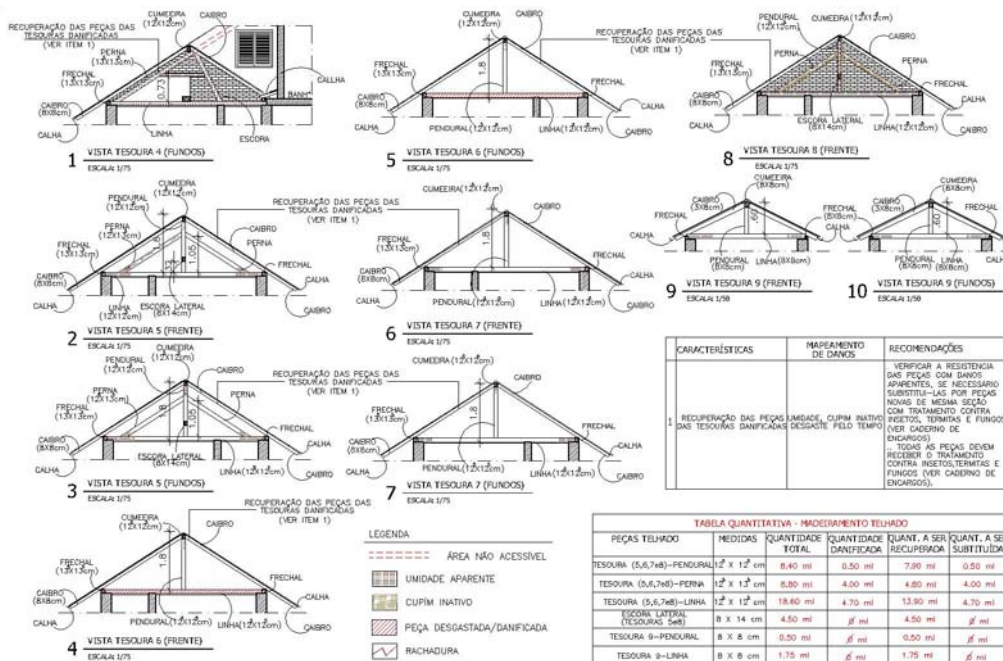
Planta com vistas das tesouras do telhado com danos e indicações de procedimentos de restauro. Projeto de restauração de telhado do Chalé do Palácio do Barão do Rio Negro, no centro de Petrópolis, RJ. Fonte: Arquivo Bk Arquitetos Associados Ltda.
